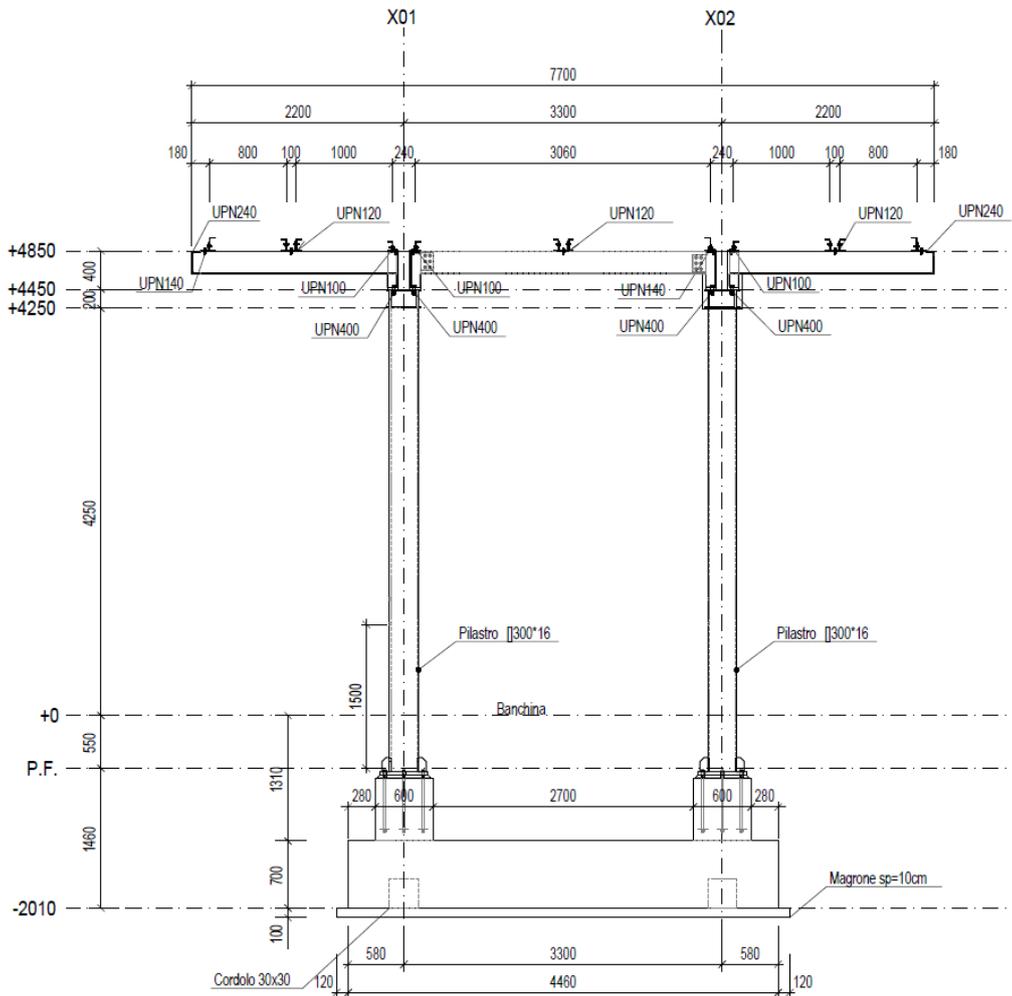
Pensiline – Sezione trasversale della pensilina a doppia falda – Pensilina Nord
